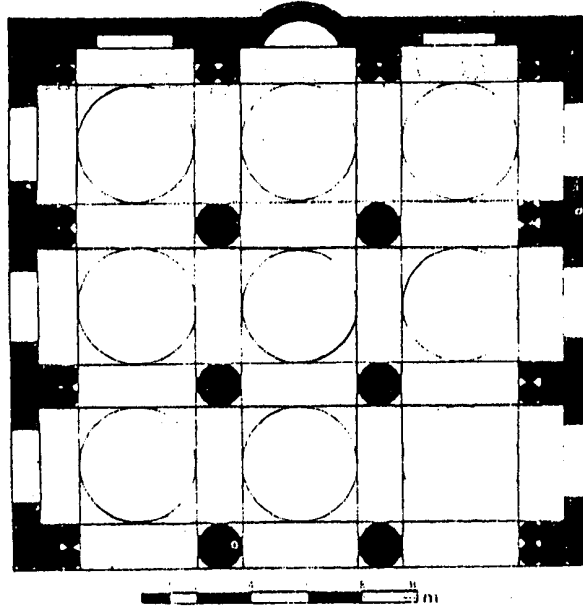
مسقط أفقي لمسجد بوفتاته في سوسة بتونس (عن : Creswell)
